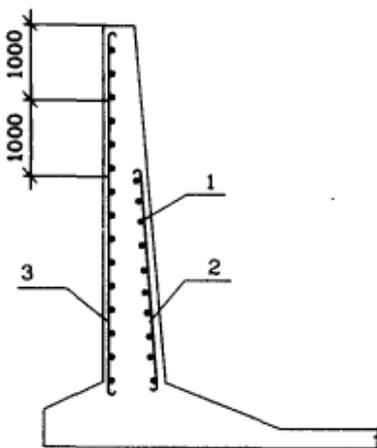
Схема армирования цилиндрической стенки резервуара:
